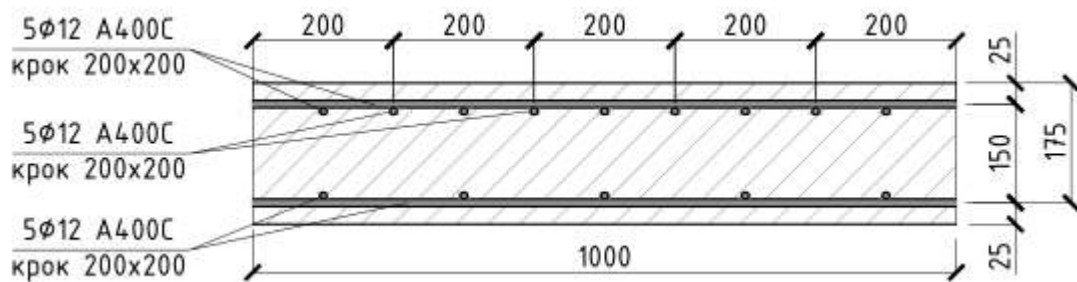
Верхня розкладка додаткової арматури на опорах.
